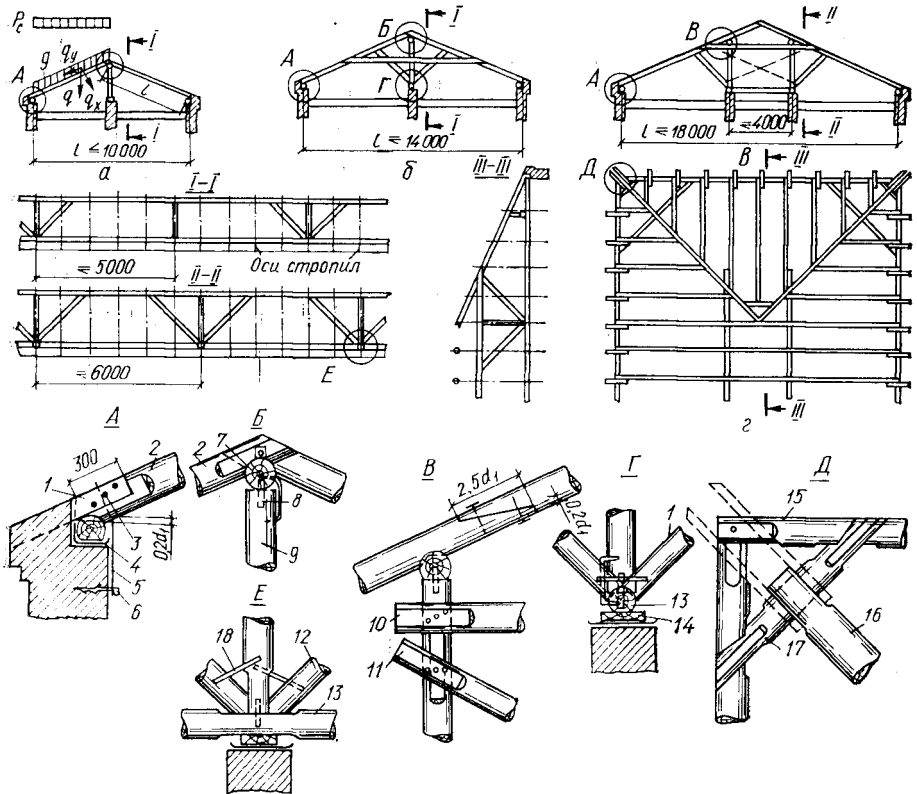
Схемы и узловые соединения наслонных стропил:
